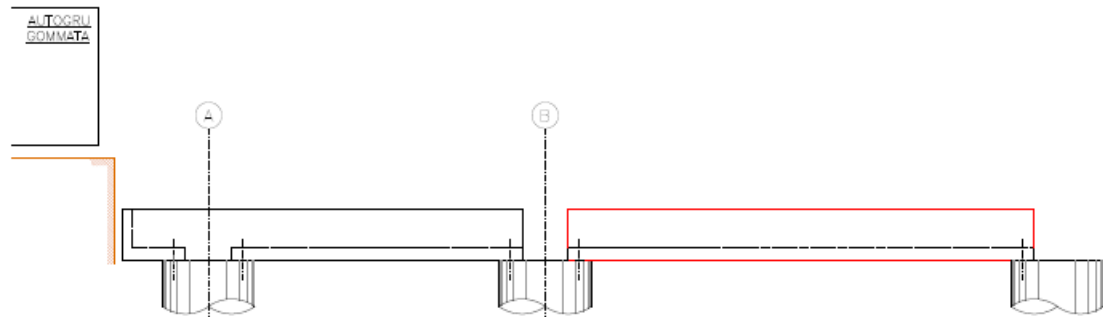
Fase 2 - Collocazione travi prefabbricate
